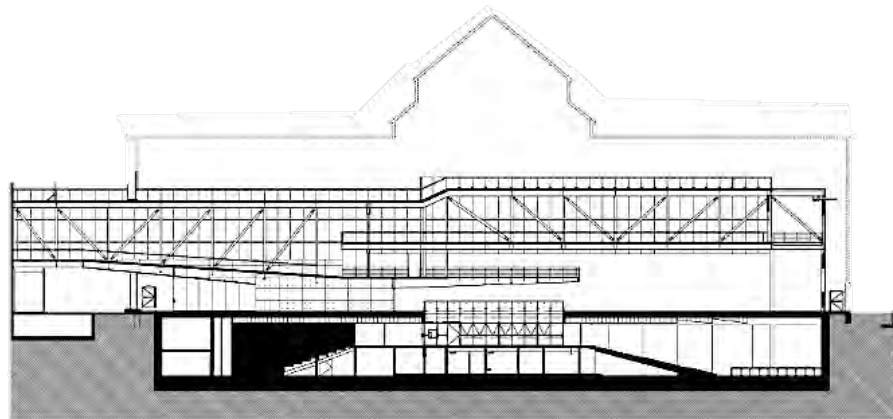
Corte transversal de la remodelación de Enrique Norten.
